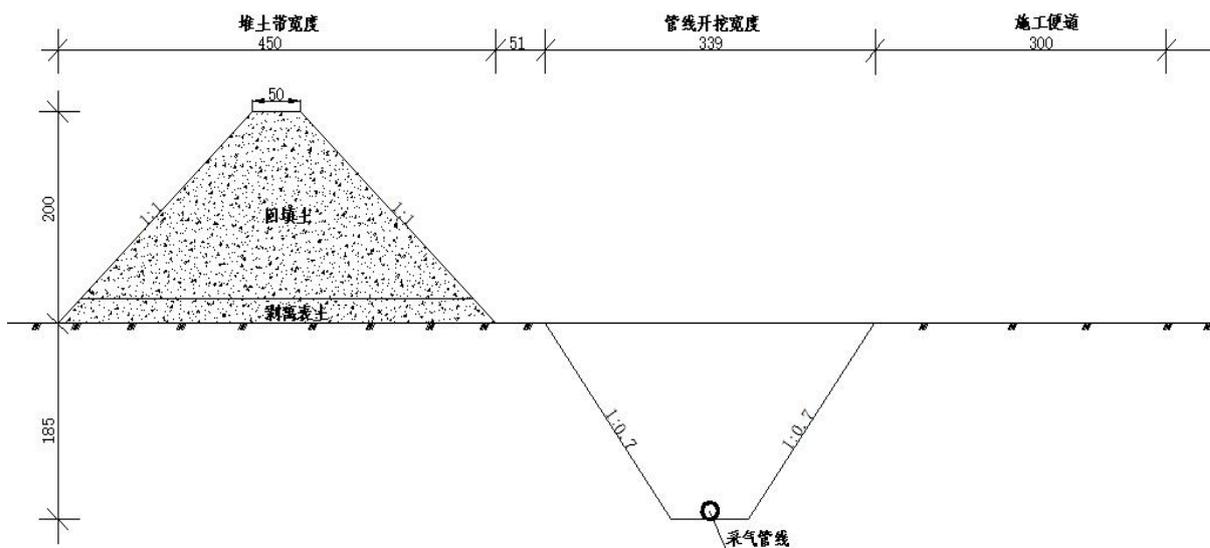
采气管线开挖断面图 (单位: cm)
